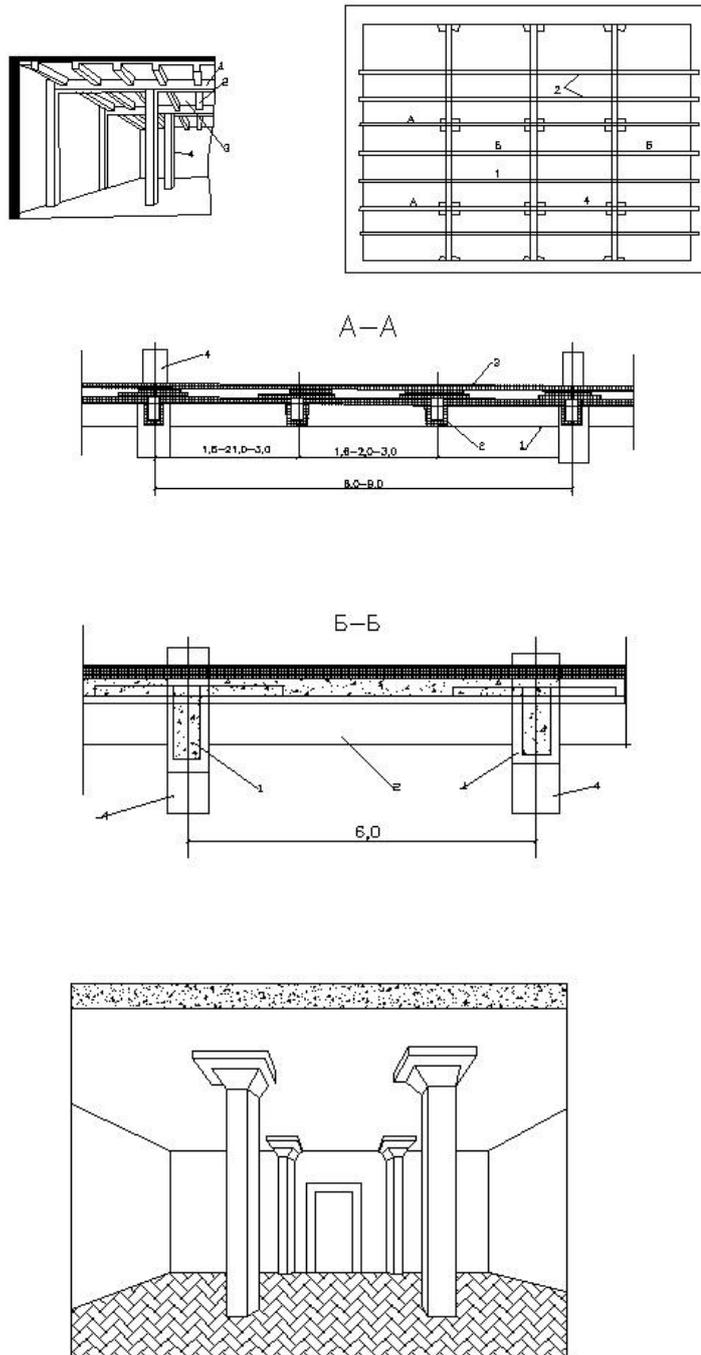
Монолітні залізобетонні перекриття: а) ребристе; б) безбалочне;
